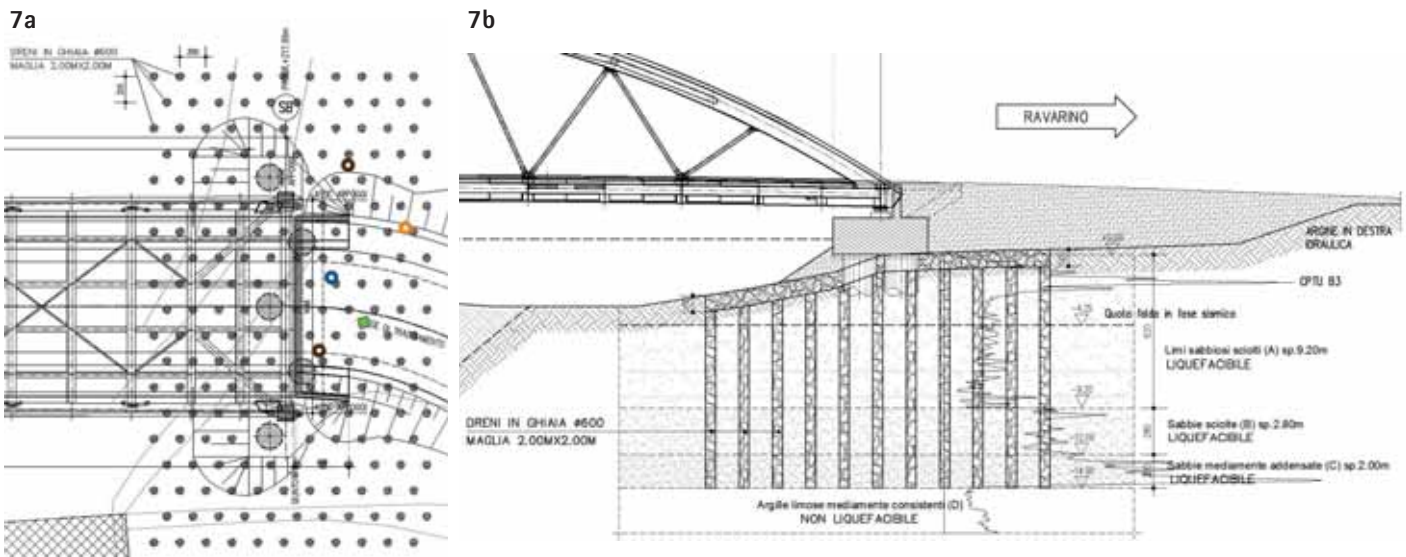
Planimetria (a) ed altimetria (b) dei pali in ghiaia
